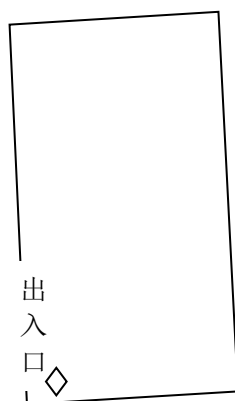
施工现场监测点位布置图 图例: ◇ PM₁₀ 监测点位
